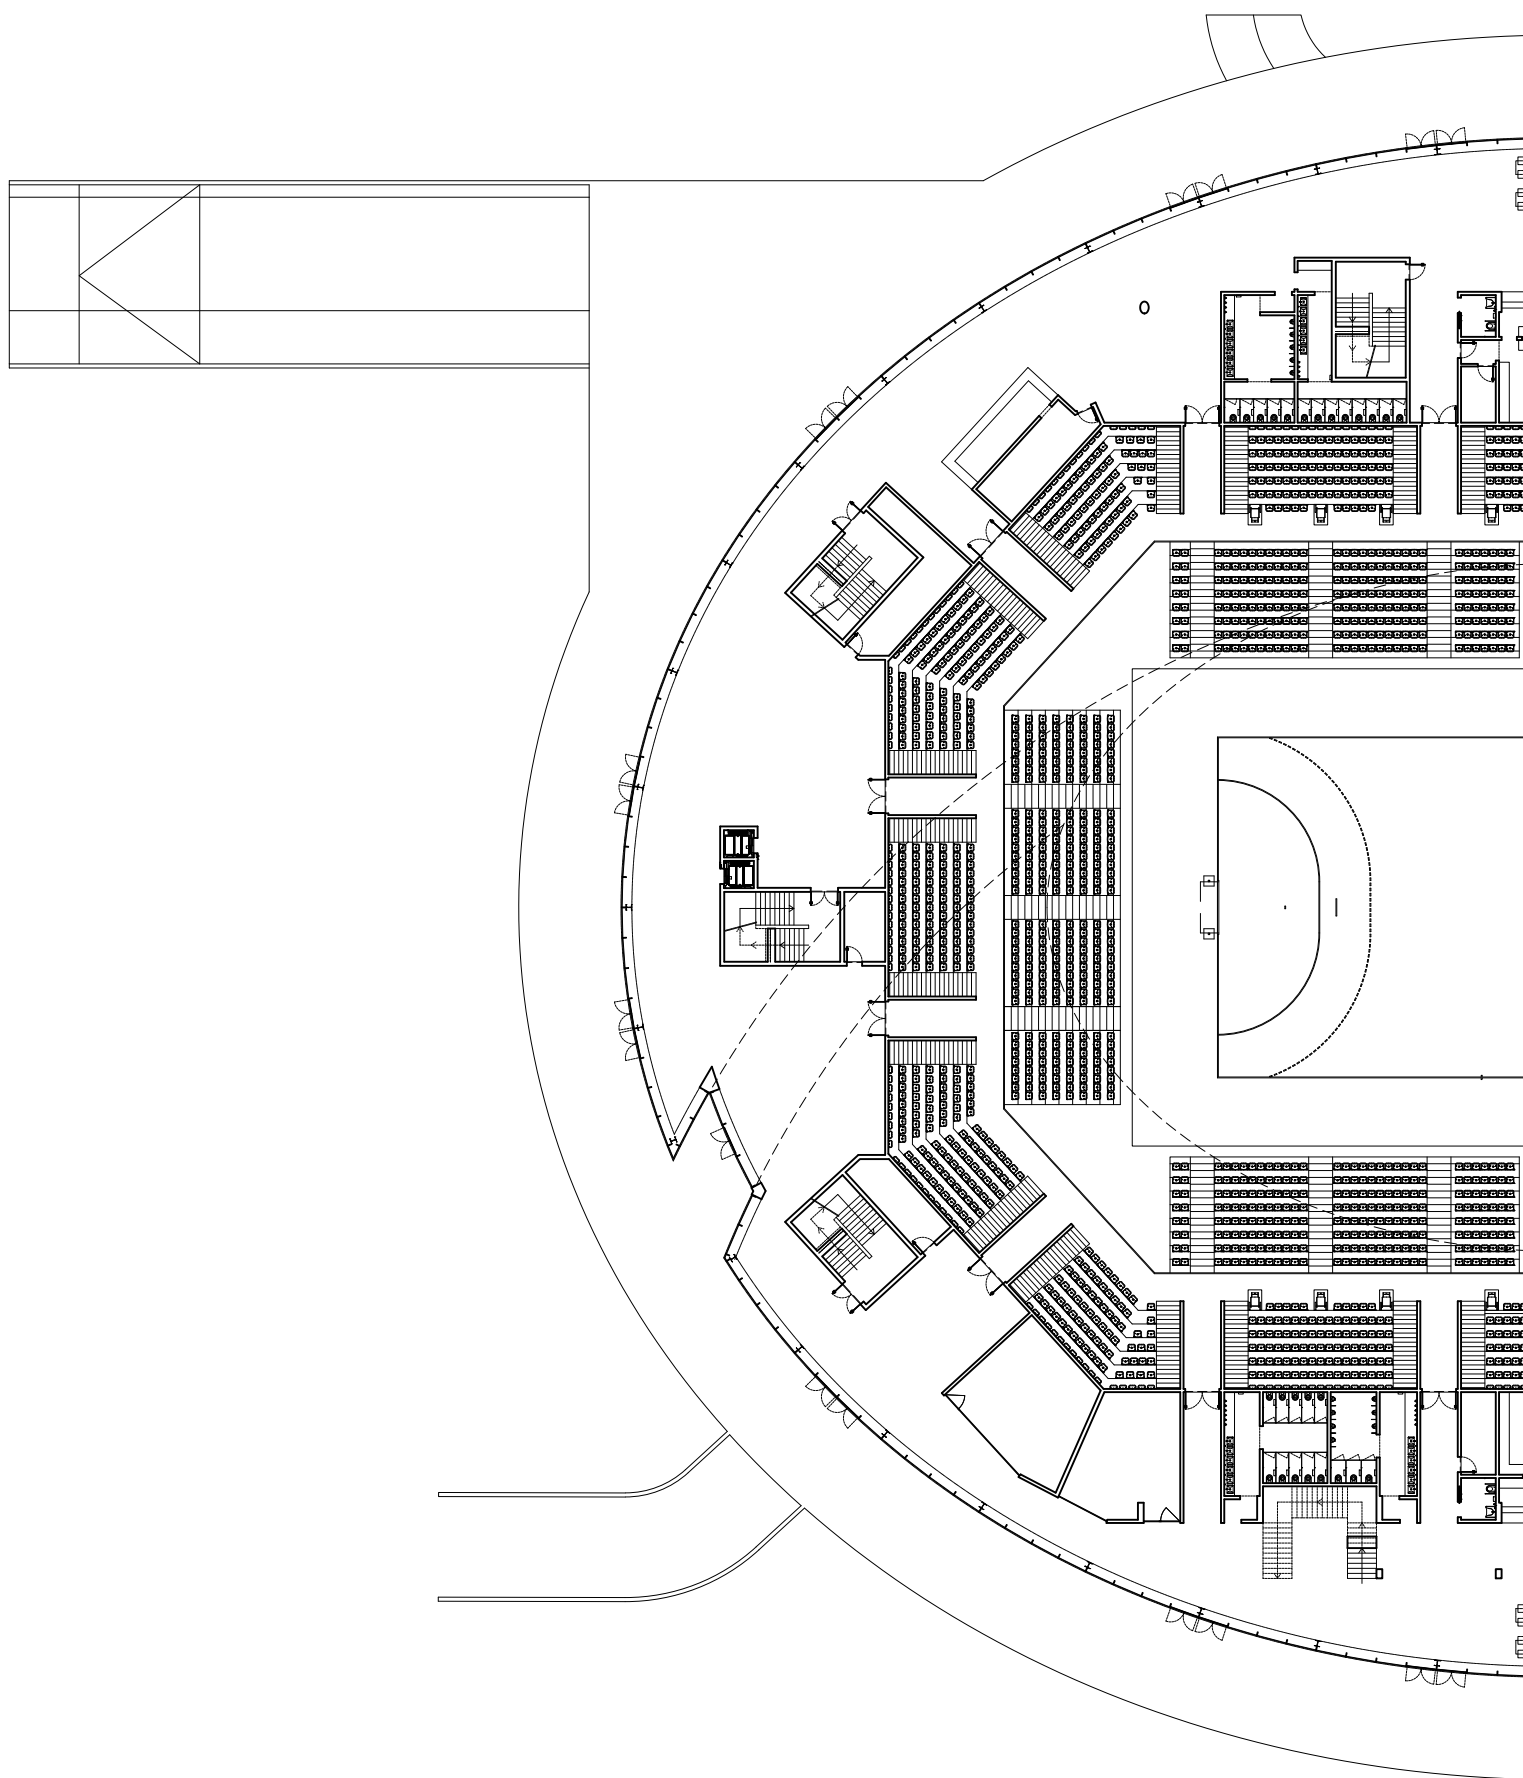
A.1.02 - Planta de Piso 0 - do autor
